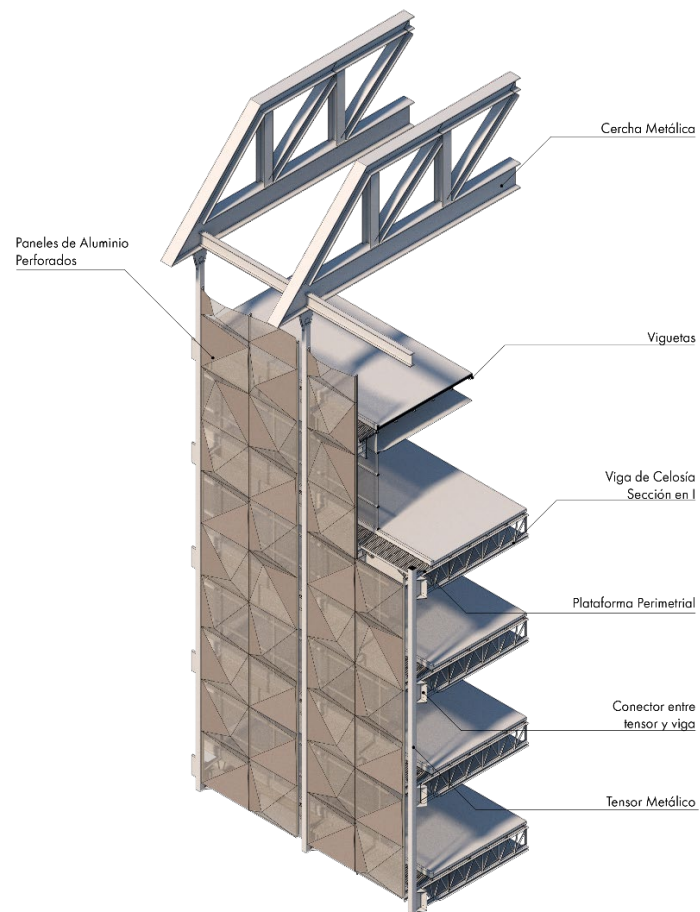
Detalle. Fachada ventilada. Elaboración propia.
